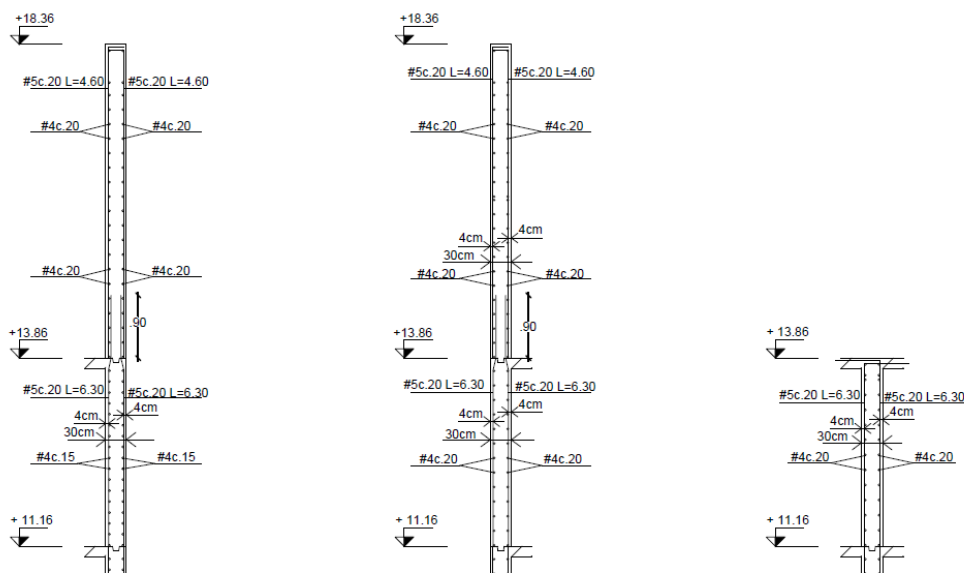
Construcción de elementos verticales sobre el nivel N+11,16, Armado de vigas nivel N+13,86.
